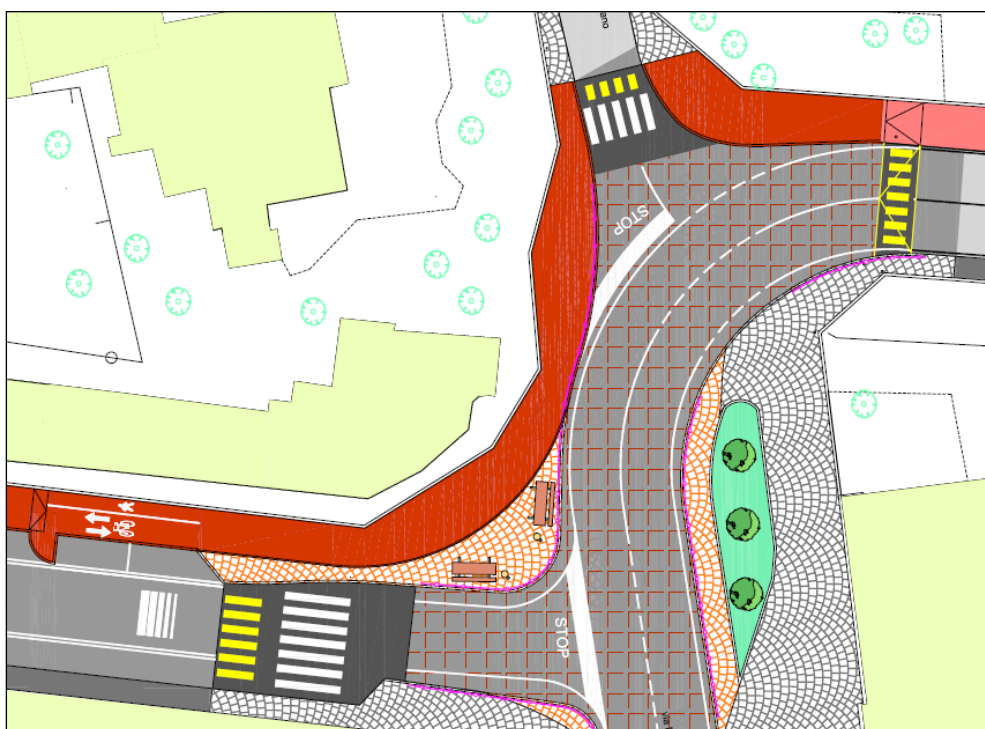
Dettaglio collegamento ciclabile tra via Sauro e via Don Carrera
